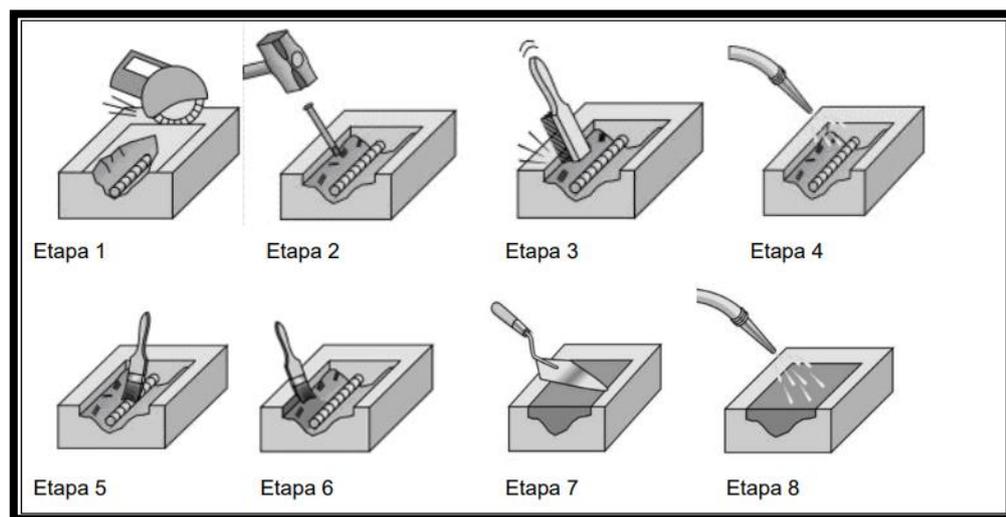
Ilustração das etapas de reparação localizada em estrutura de concreto armado
